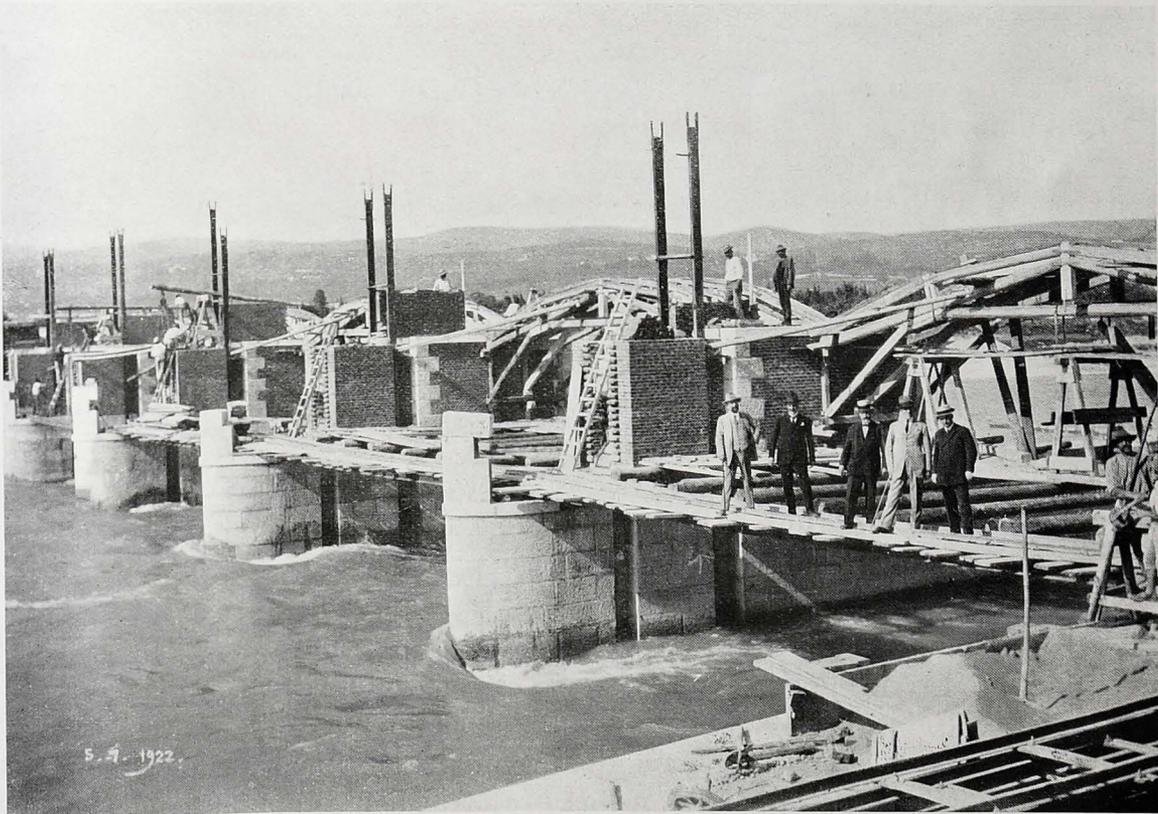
SOPRAELEVAZIONE DELLE PILE
